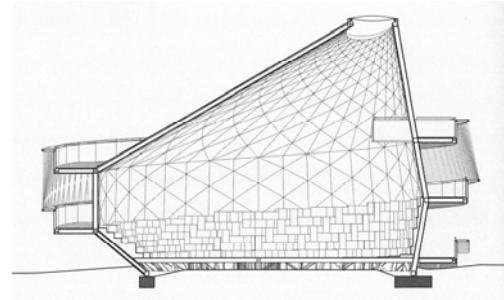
Corte, pavilhão de Olafur Eliasson e Kjetil Thorsen, 2007.
